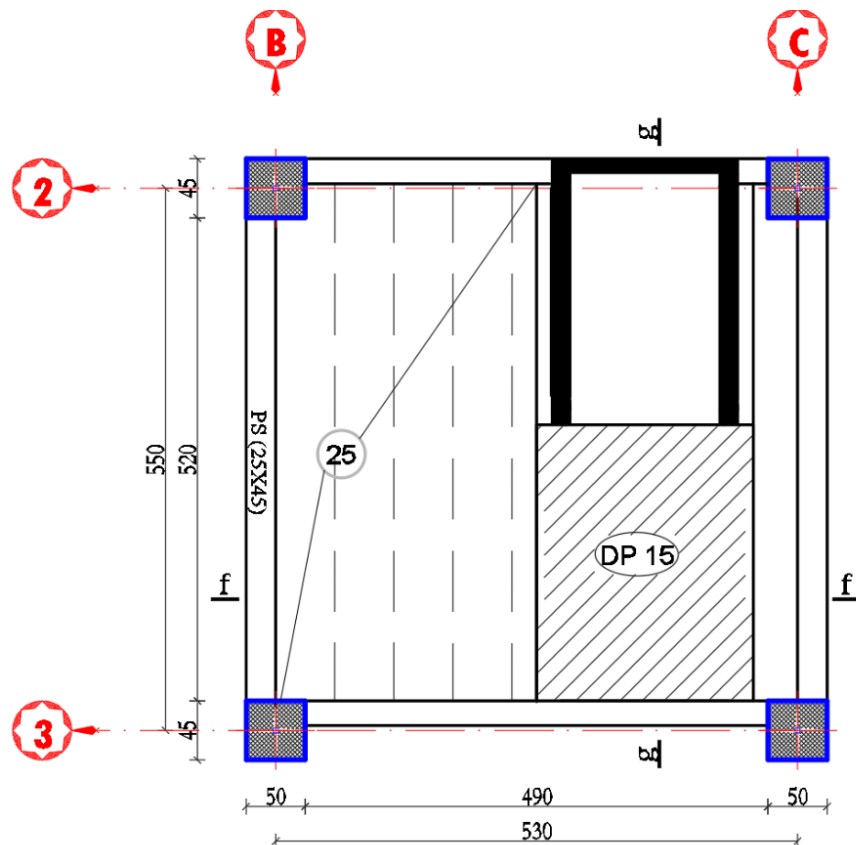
Vue en plan dalle pleine hall ascenseur
